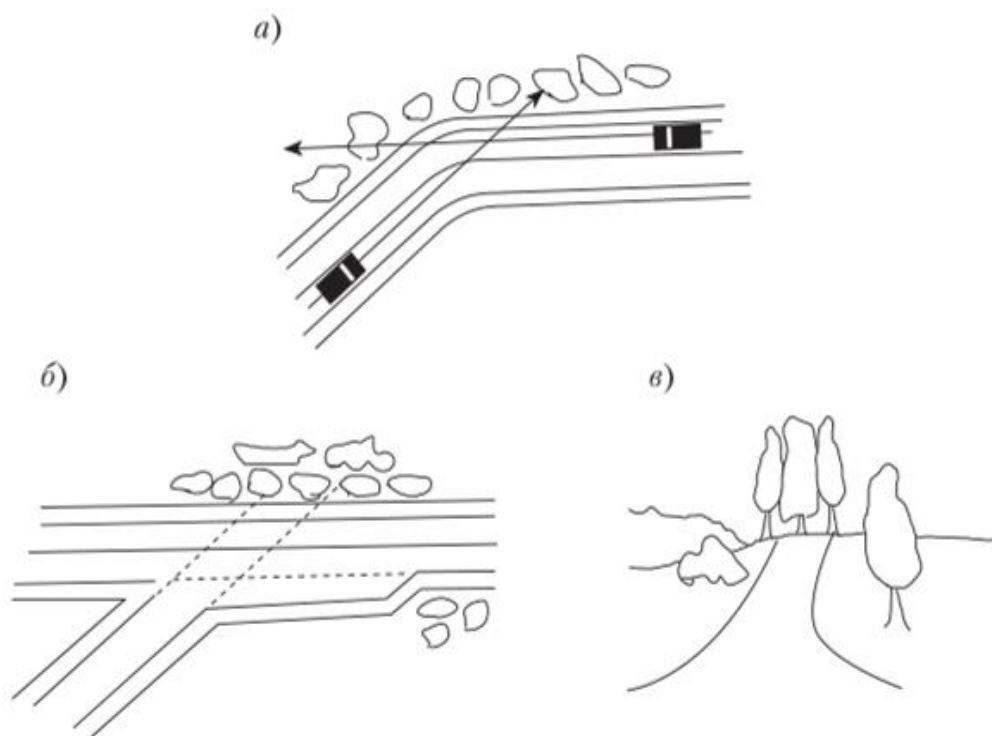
Направление посадки на кривых в плане (а); барьерные посадки у примыканий съездов к дороге (б, в)
